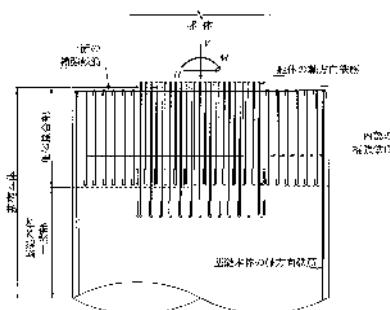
橋脚と大口径深礎との接合部の配筋標準図
